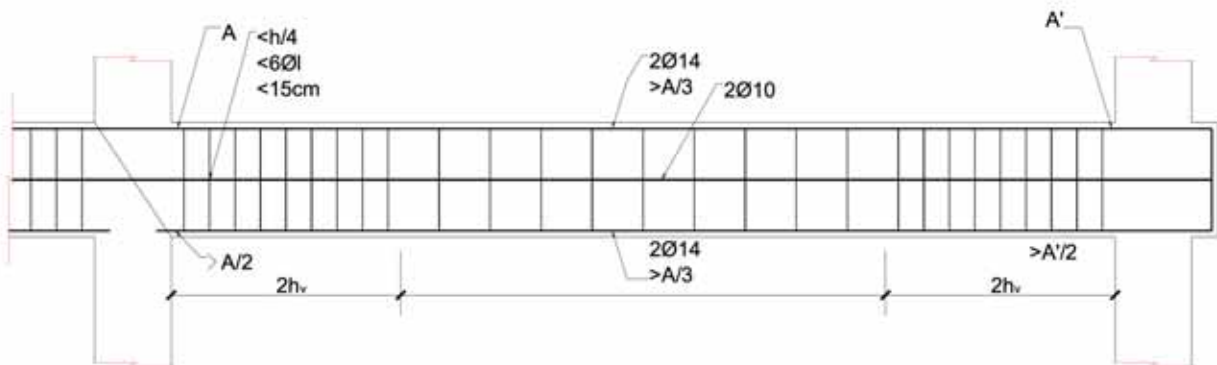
Detalle de confinamiento y armado de una viga de acuerdo con la norma NCSE-02.
